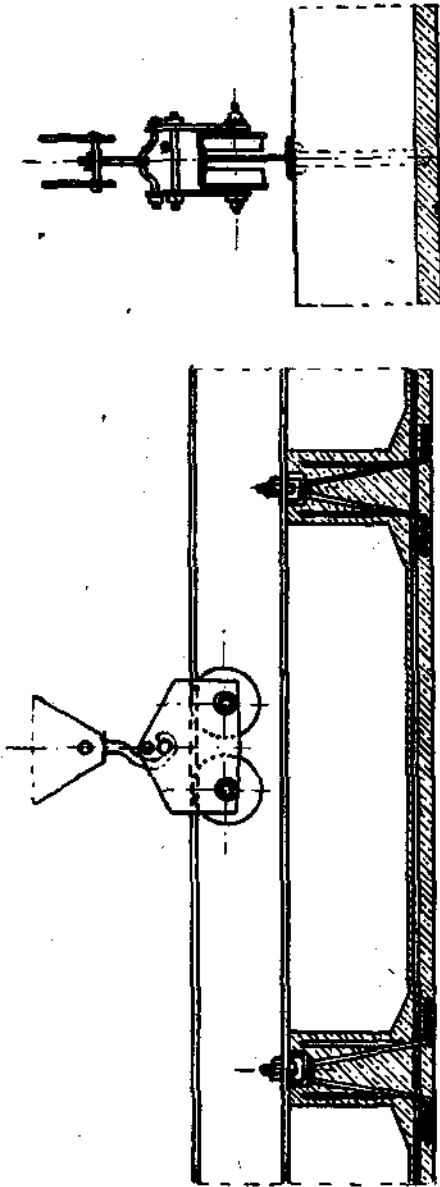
Подвешивание трансмиссий к железобетонному перекрытию.
